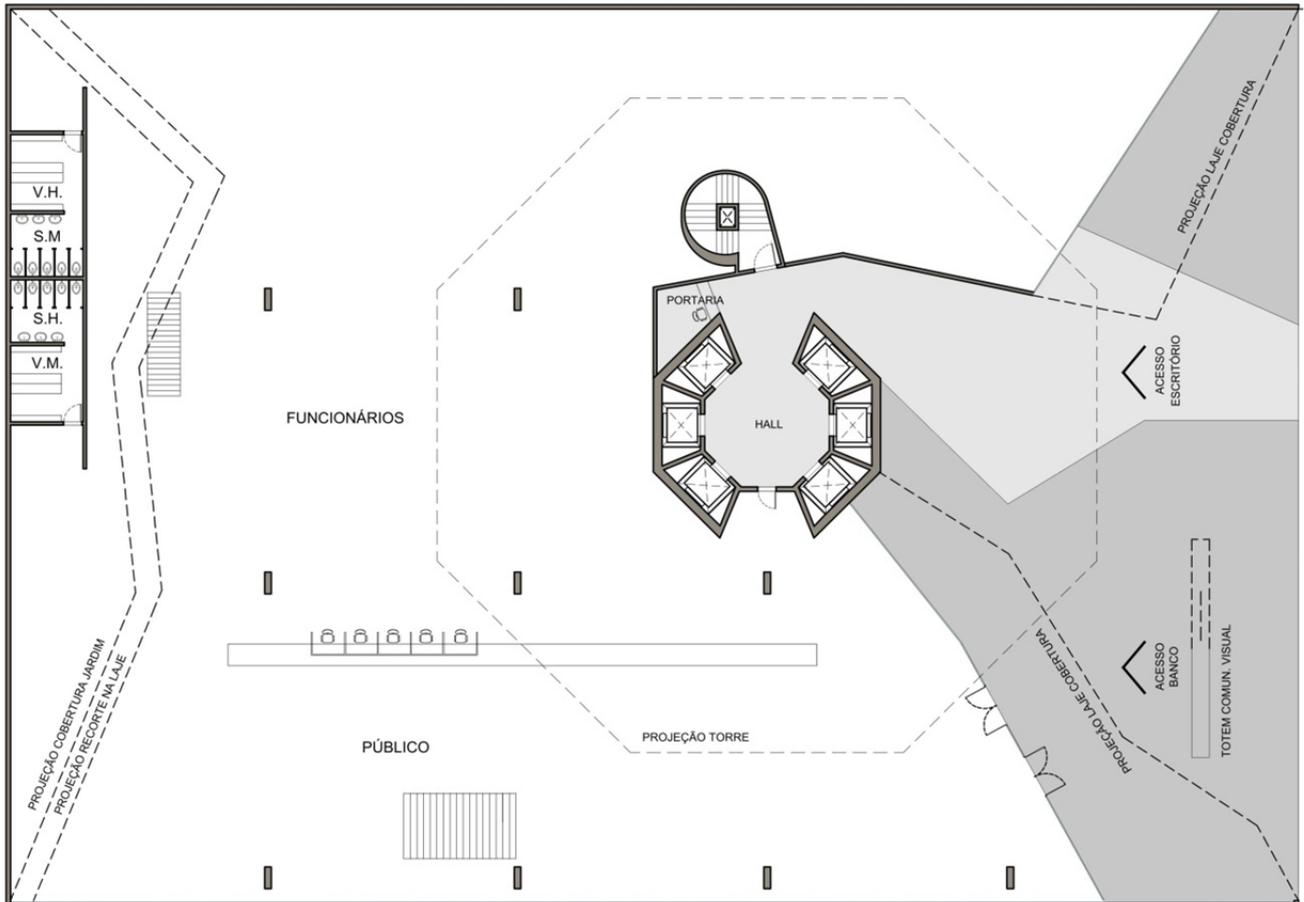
Planta do pavimento térreo superior sede Banco Safra
